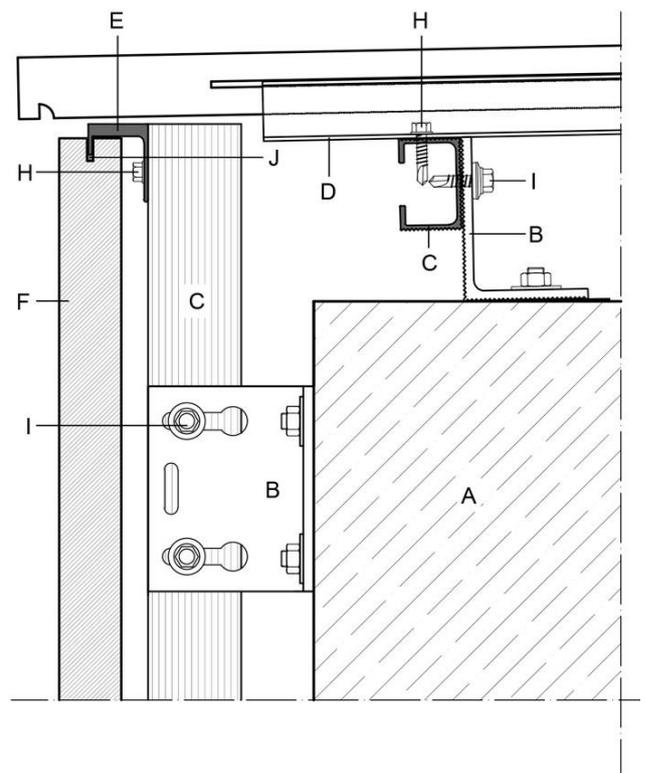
DETALLE DE ESQUINA EXTERIOR
